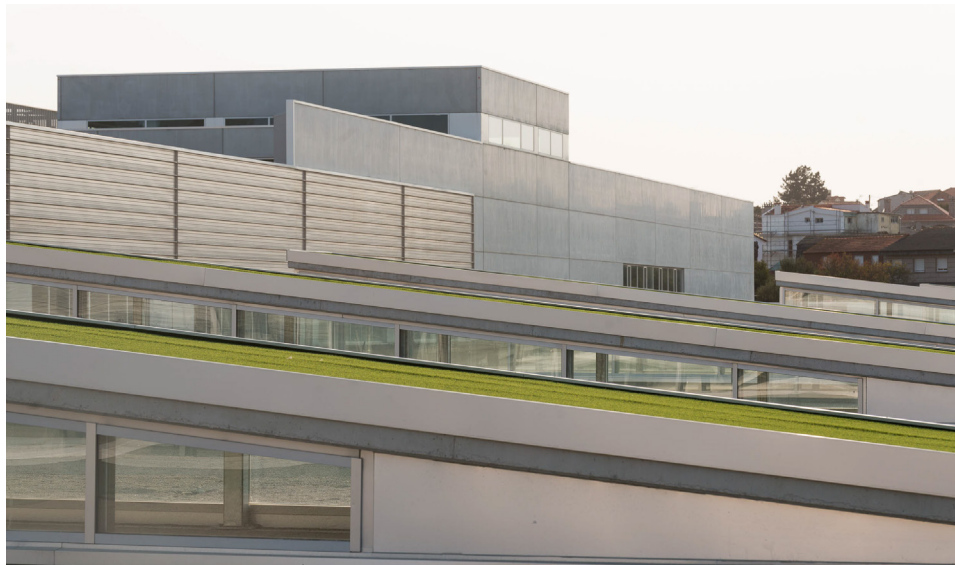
| Vista general de la cubierta y lucernarios de la zona de decantación primaria.
